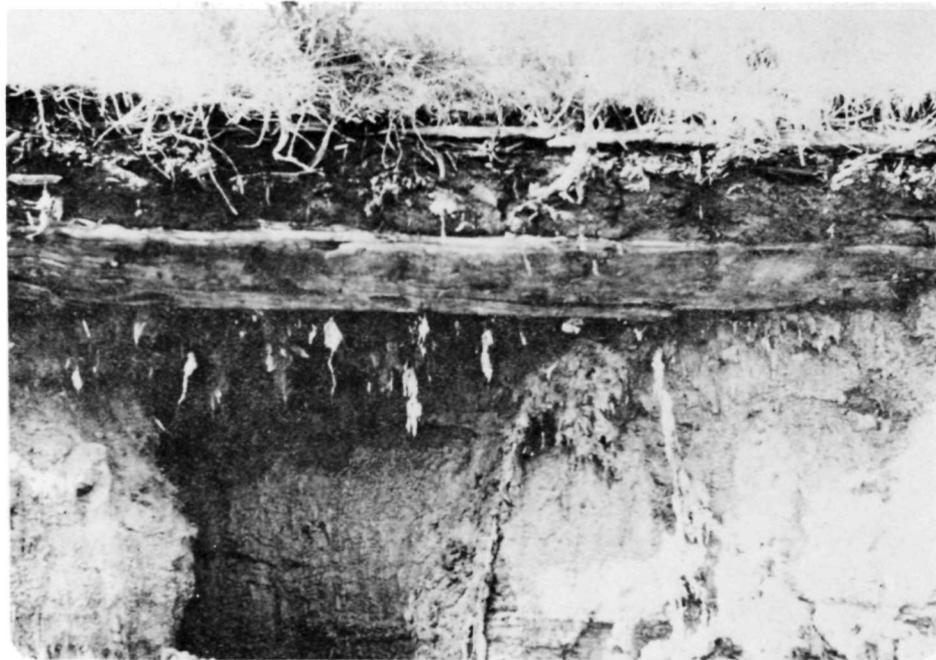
Section de la promenade en planches sur le point de s'effondrer, prise en direction ouest (photo: J. Hamilton).
